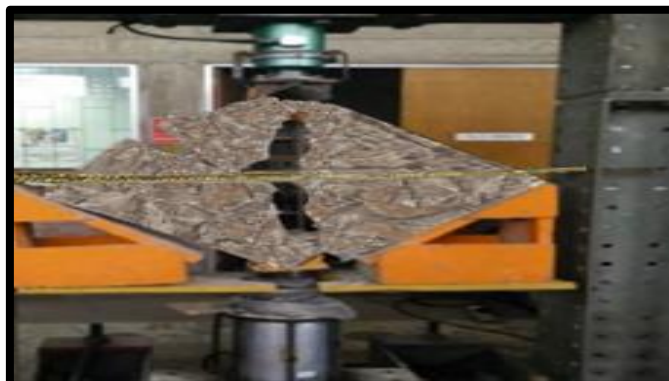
Fallas del murete de pirca sin reforzamiento
